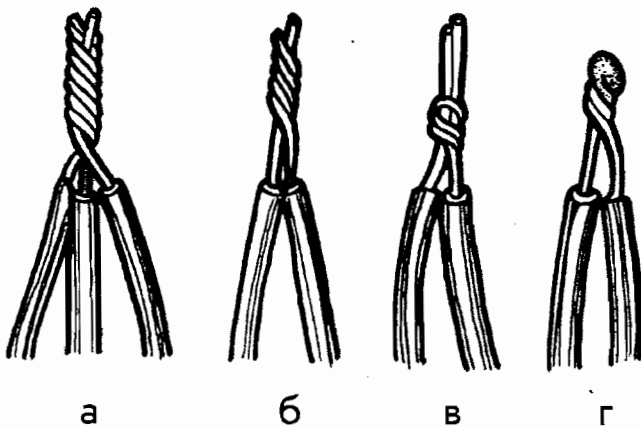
Скрутка жил под сварку: а — алюминиевые жилы; б, в — алюминиевая и медная жилы; г — сварное соединение.
